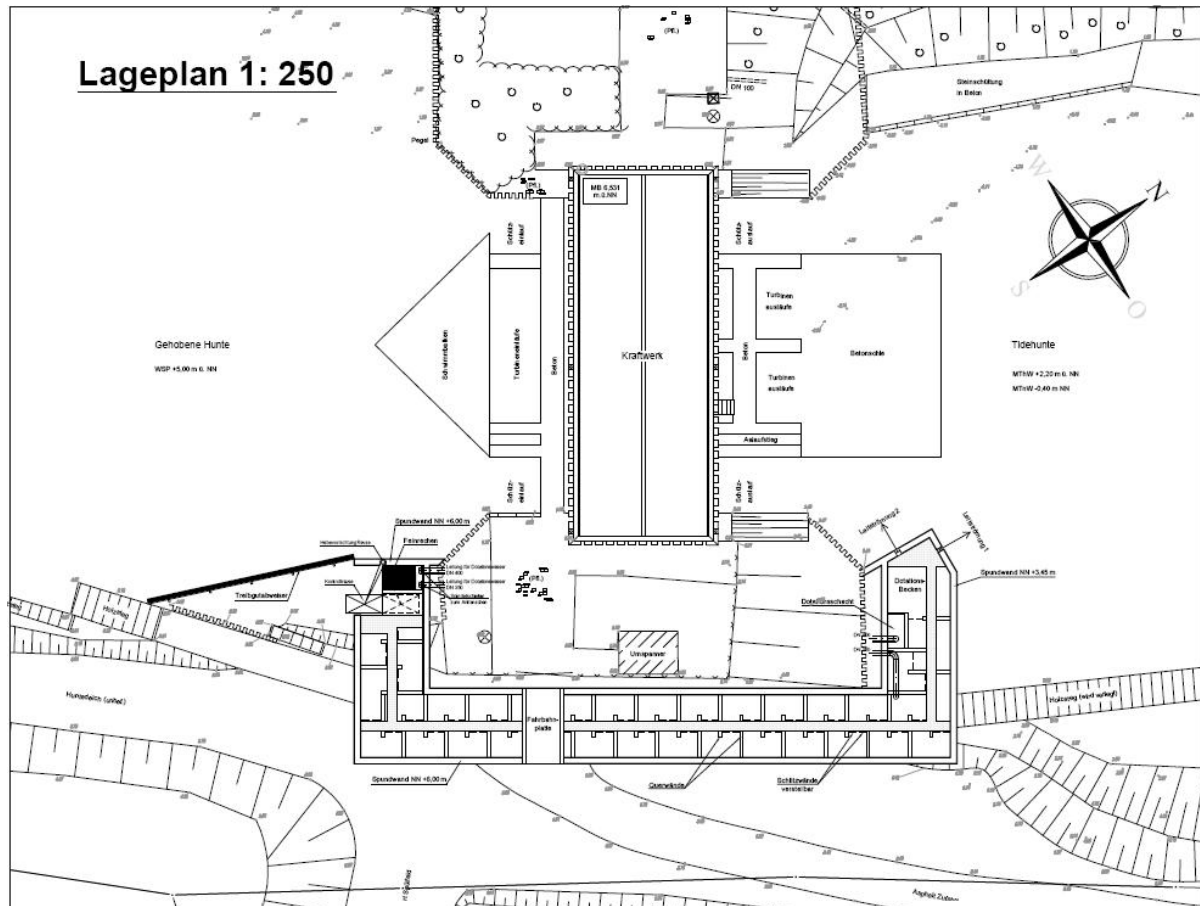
Lageplan Kraftwerk Oldenburg
